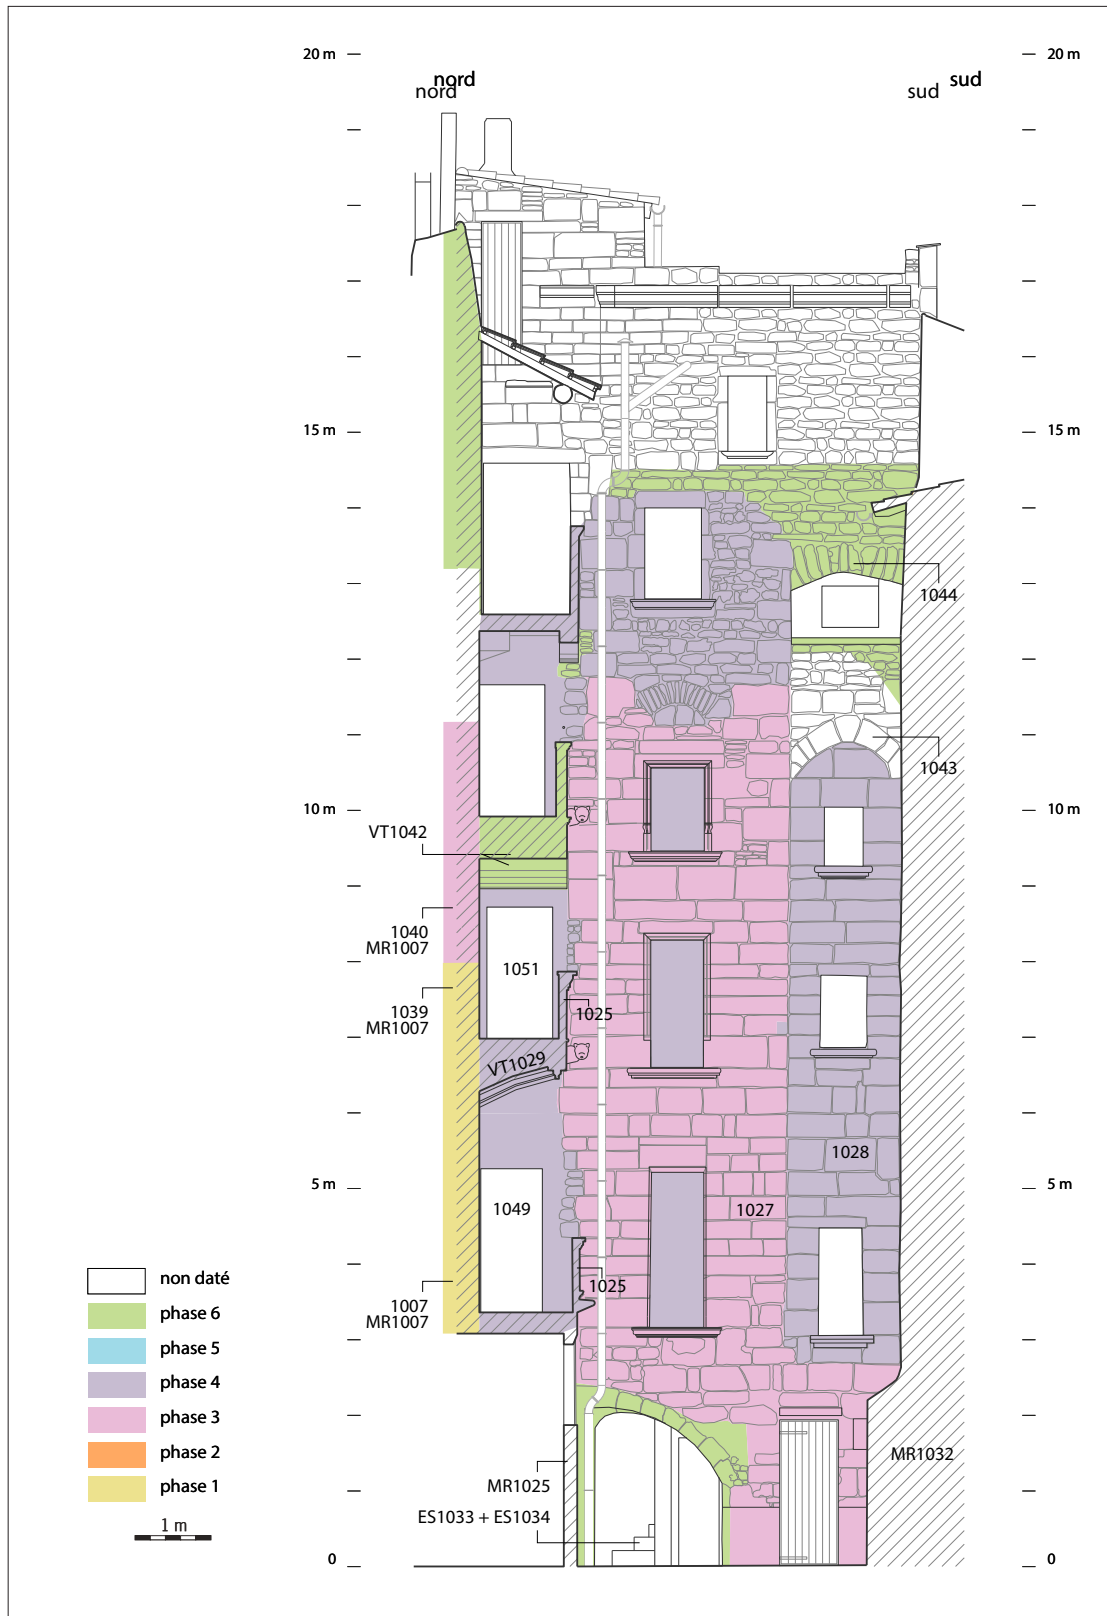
Section nord-sud de la cour avec la façade méridionale MR1007 doublée des loggias en coupe et l'élévation du mur MR1025 de l'escalier en vis. Étapes de construction reconnues. Fond de plan : SARL NDA.
